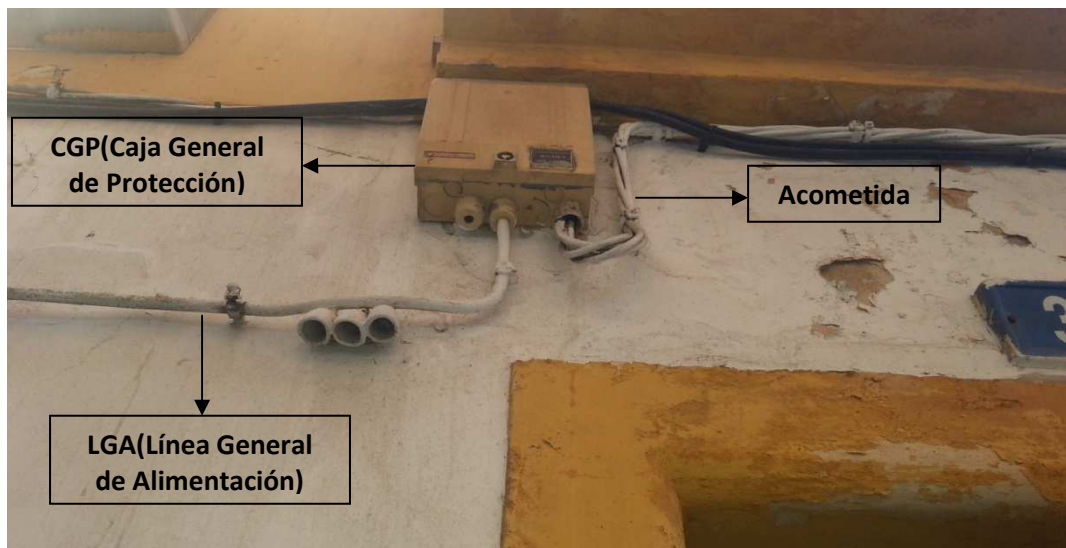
Caja General de Protección, ubicada sobre la puerta de la fachada Sur (Fuente: elaboración propia)
